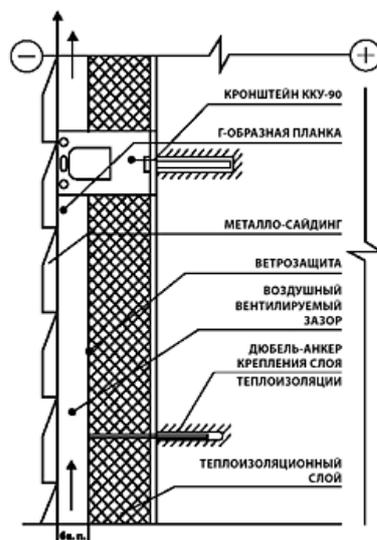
Устройство вентилируемых наружных стен в зданиях и сооружениях
